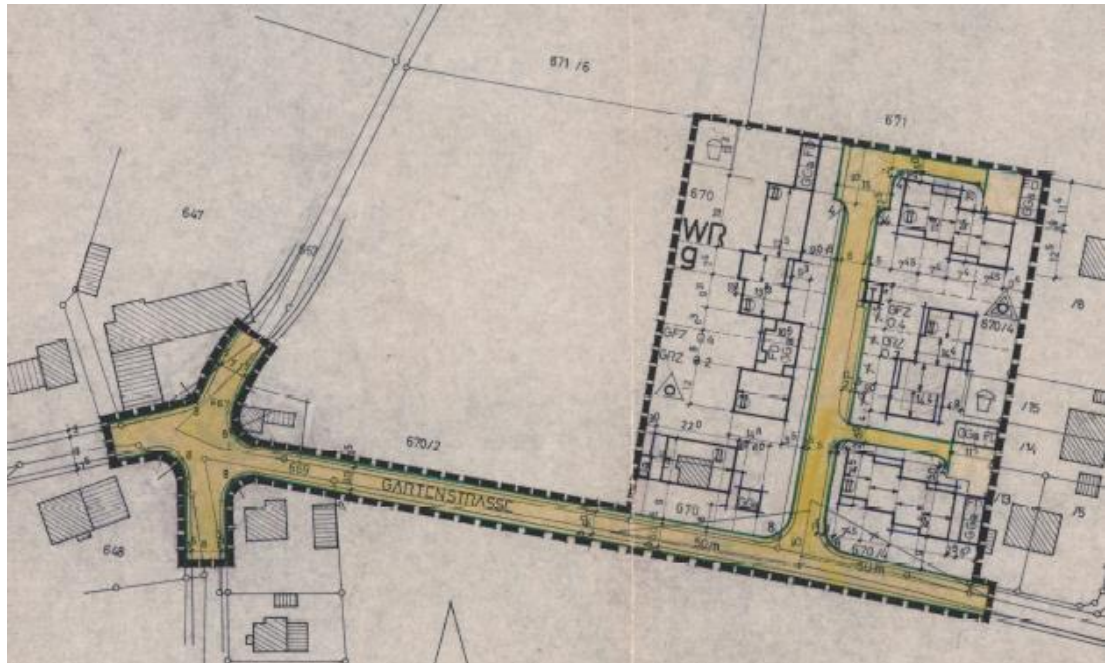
Bebauungsplan Nr. 10 (Fassung vom 06. Juni 1972)
